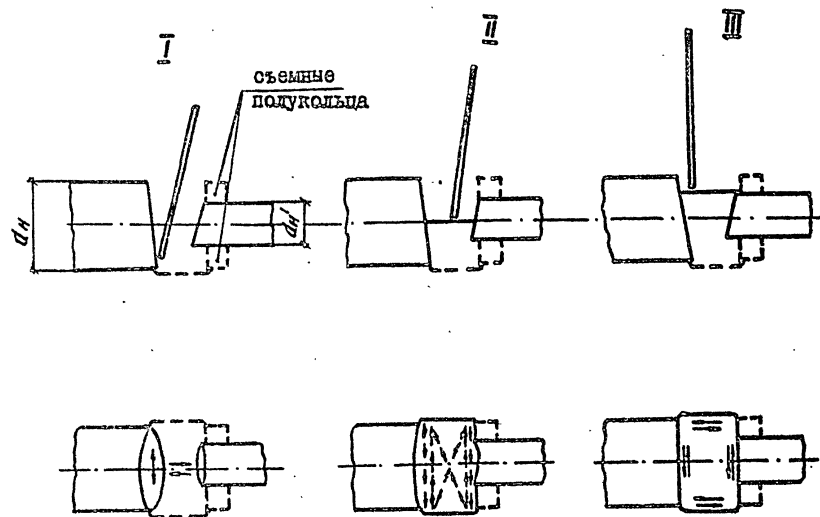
Техника механизированной сварки горизонтальных выпусков арматуры в инвентарной форме, размеры которой регламентированы для сварки стержня большего диаметра.
